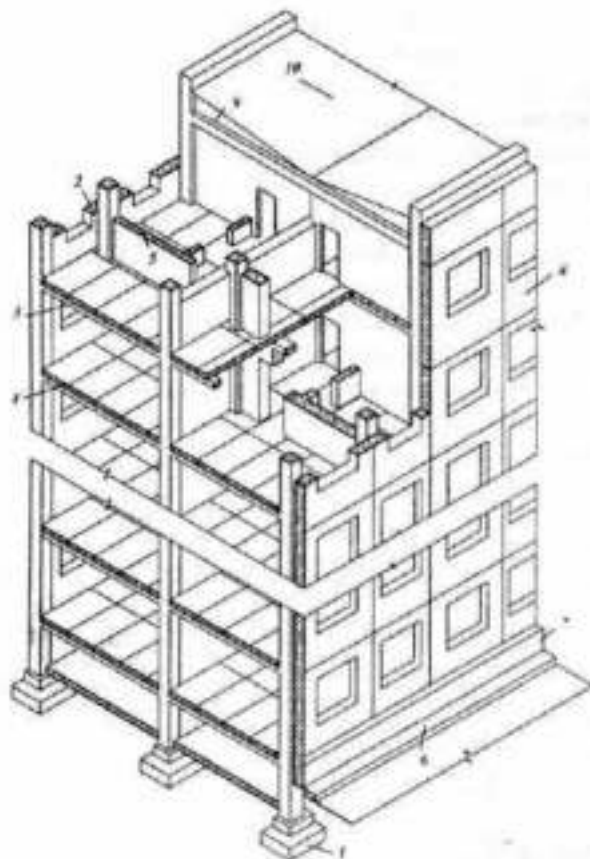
Конструктивні елементи будівлі каркасно-панельної будівельної системи:
